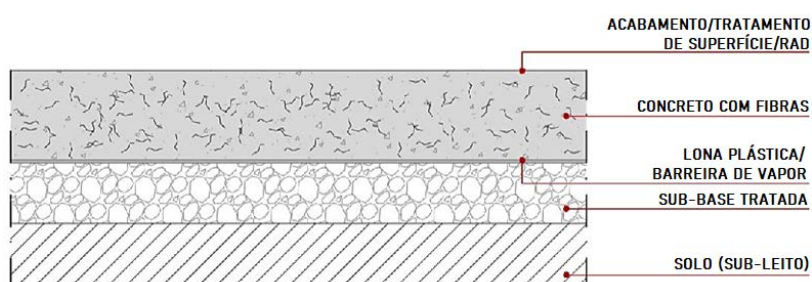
Camadas de um pavimento industrial em concreto reforçado com fibras.
